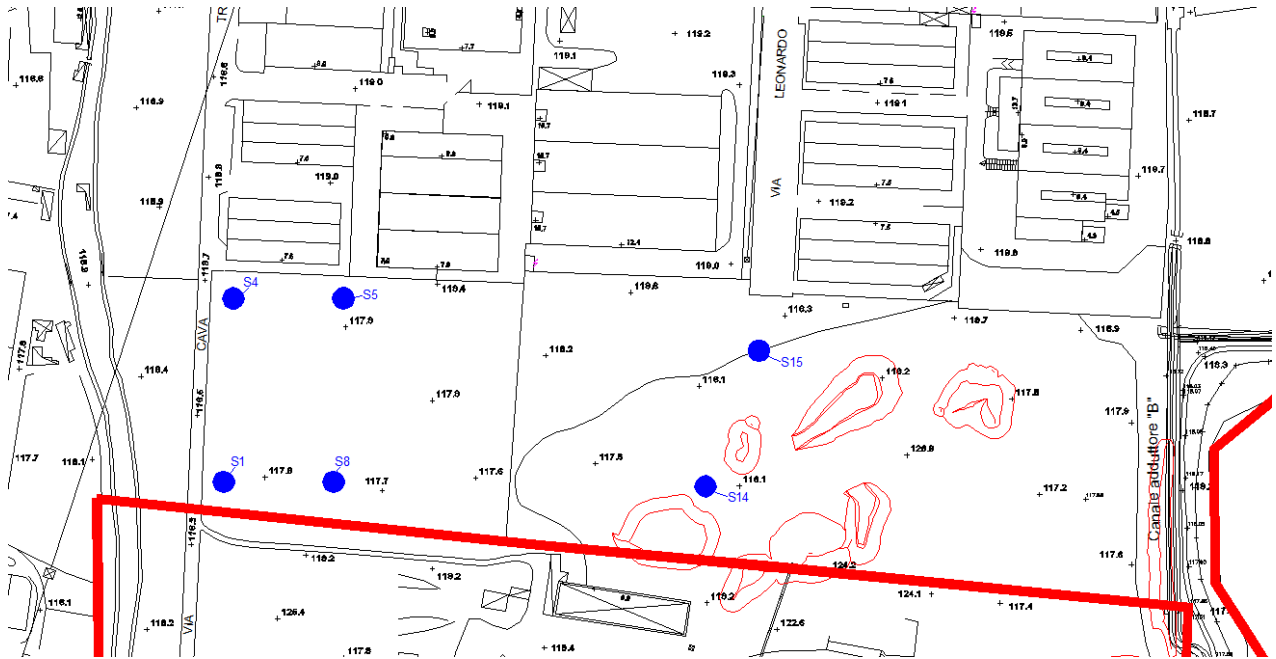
Planimetria area A1 con identificazione dei pozzetti
